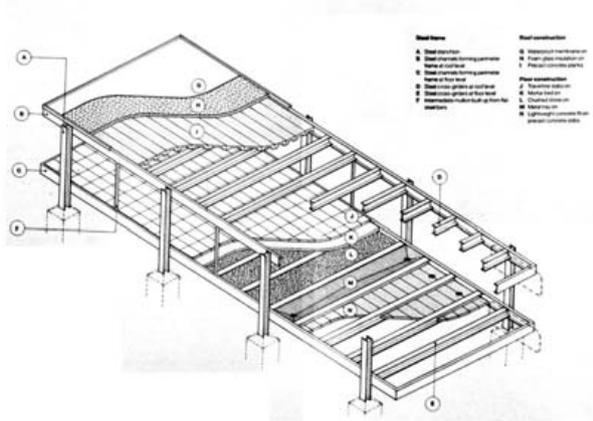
Estructuras de vigas. Casa Farnsworth, Plano, Illinois, Estados Unidos, 1945 - 1951, Ludwig Mies Van der Rohe.
